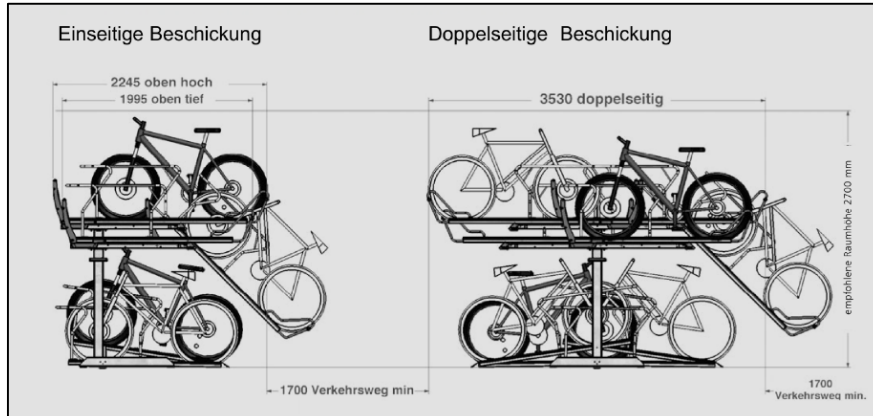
Grundabmessungen Doppelstockparken (Quelle: Fa. Orion)
